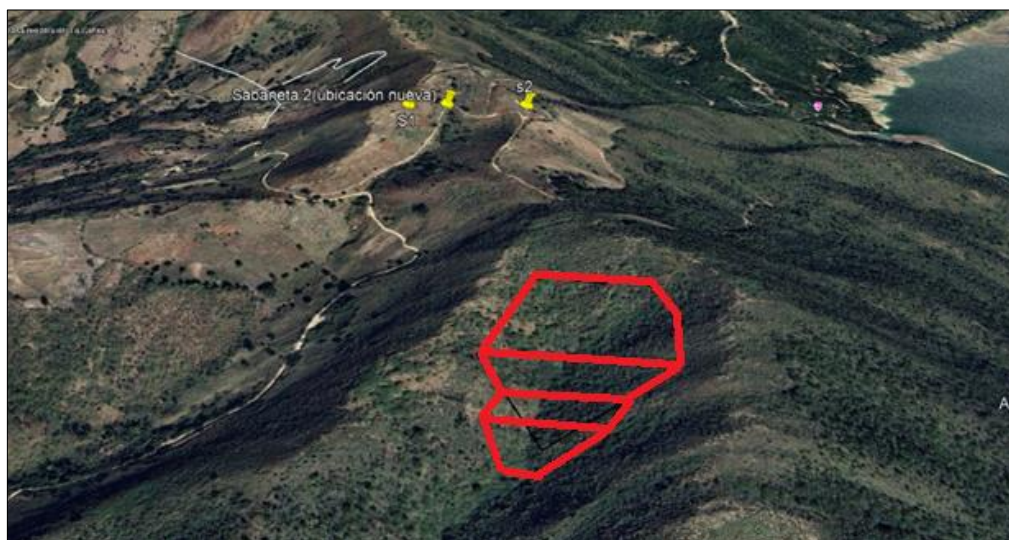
Detalle de la posible ubicación del vertedero de tierras
